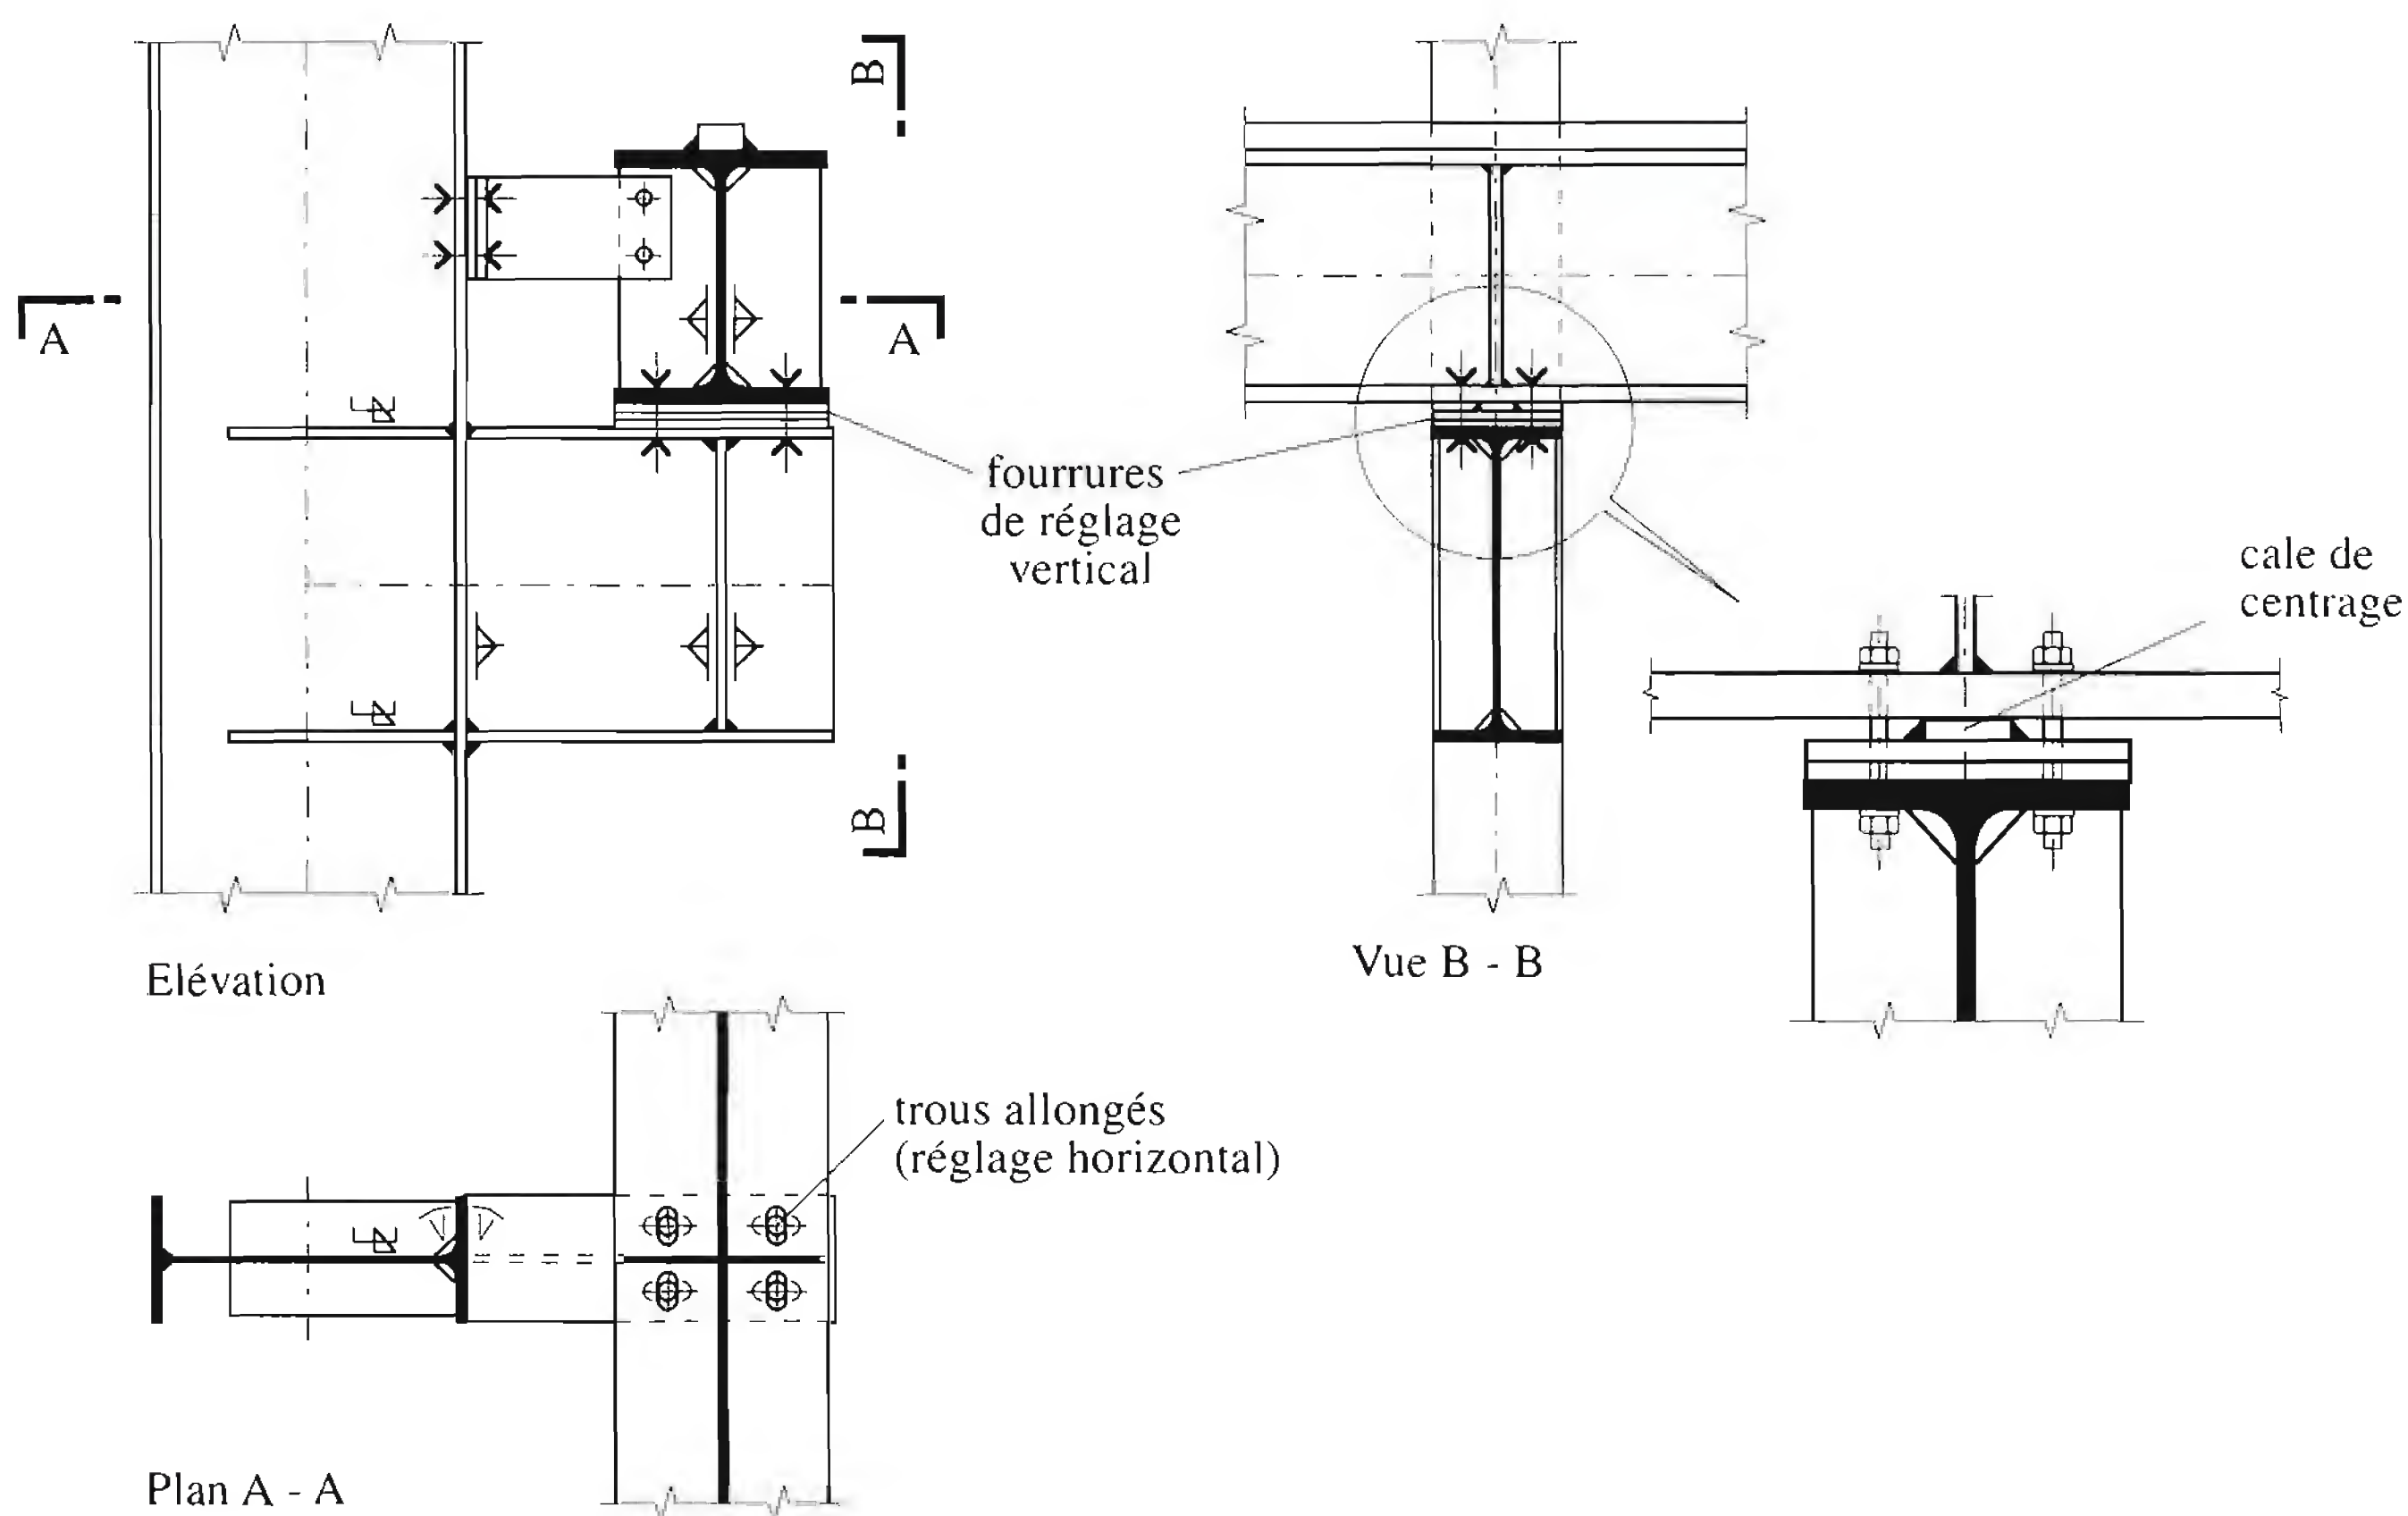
Exemple de support vertical d'une poutre de roulement.
